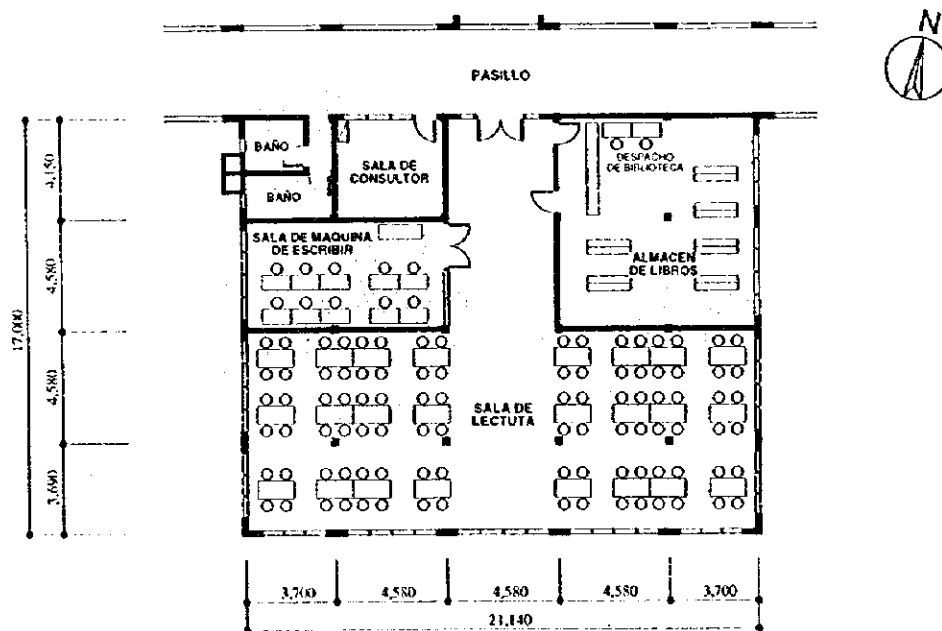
Plano del plan de segundo piso del edificio central
